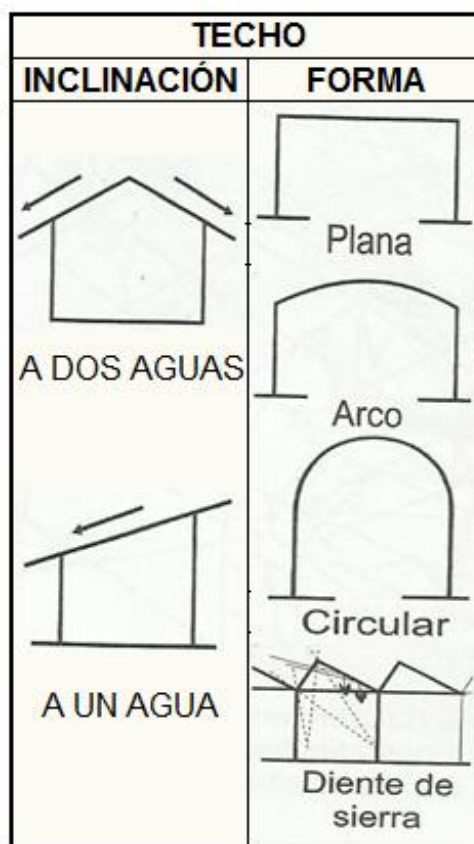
Tipos de cubiertas de techo. Fuente: (Arnal, 2007)
